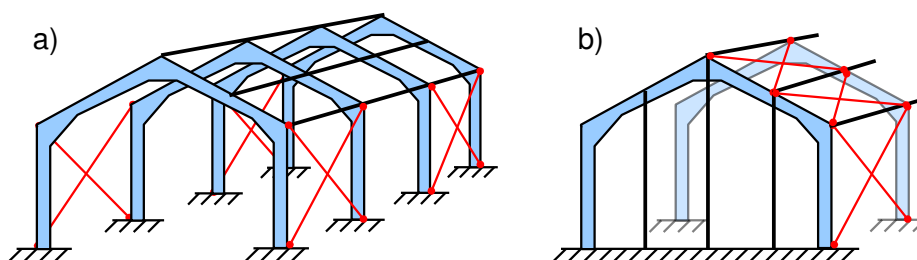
a) Arriostramiento de los pórticos en las paredes de la nave. b) Vigas verticales en el frontal de la nave, y arriostramiento en el plano del faldón actuando simultáneamente como viga contraviento.
